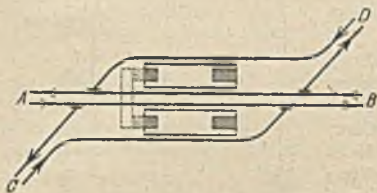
Kreuzungsstation zweier Linien mit Richtungsbetrieb.
